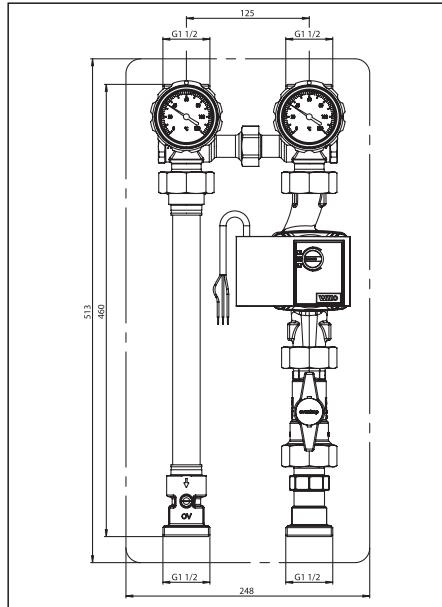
Pumpengruppe DN 25 180 mm mit Pumpenkugelhahn
